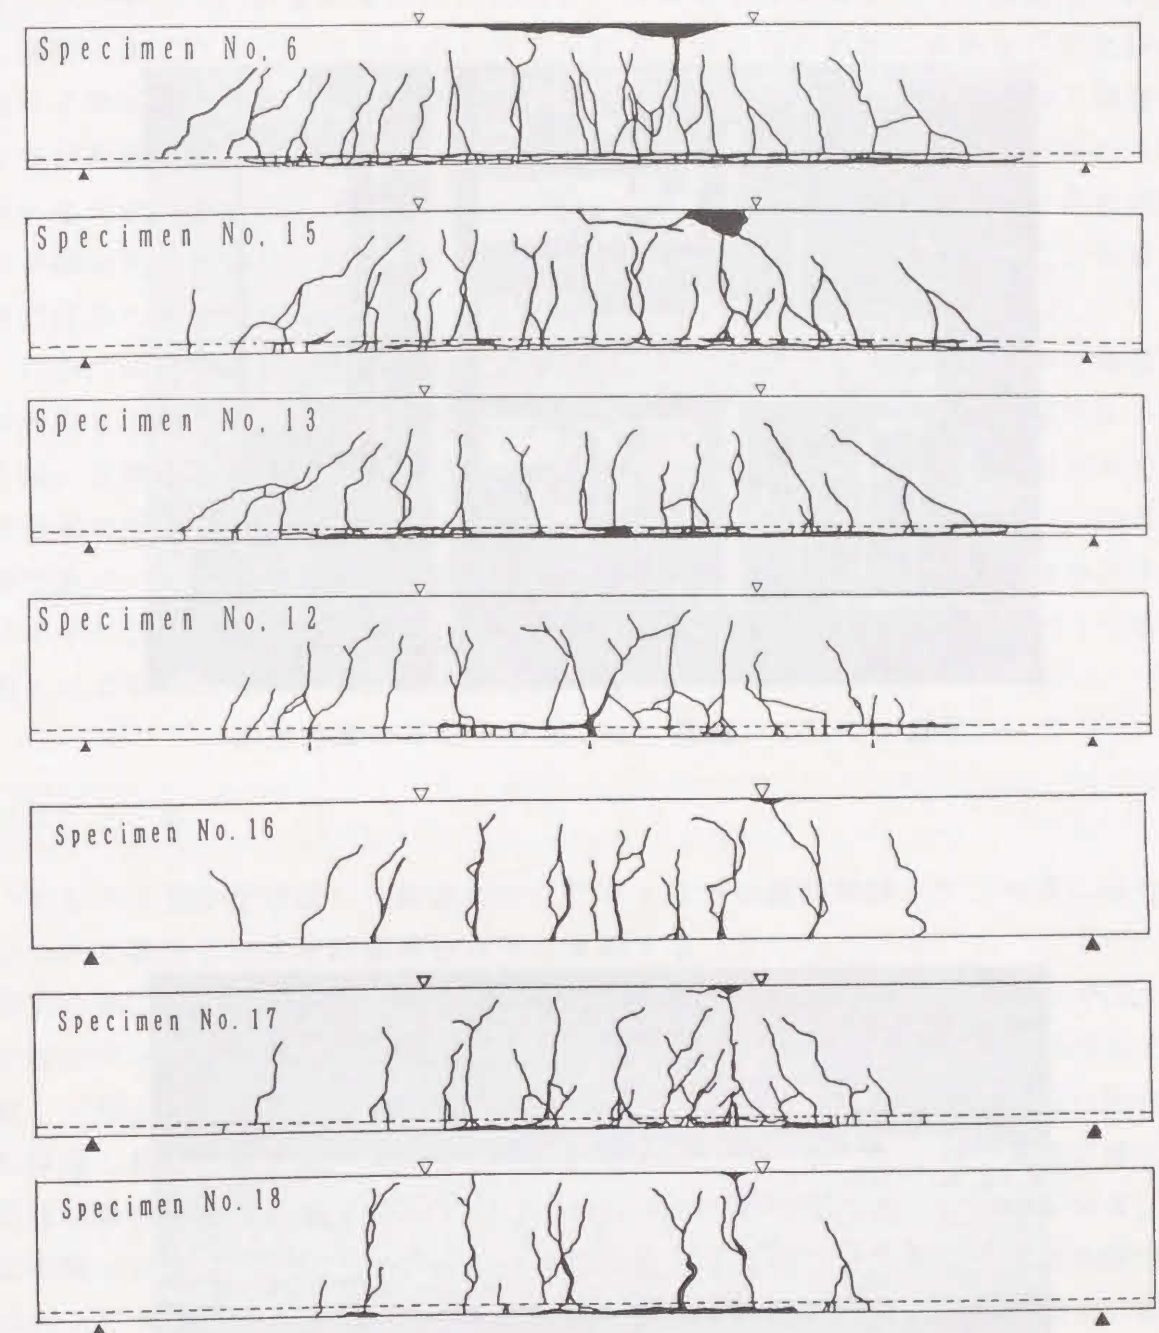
鉄筋コンクリートはりのひびわれ状況(2)
